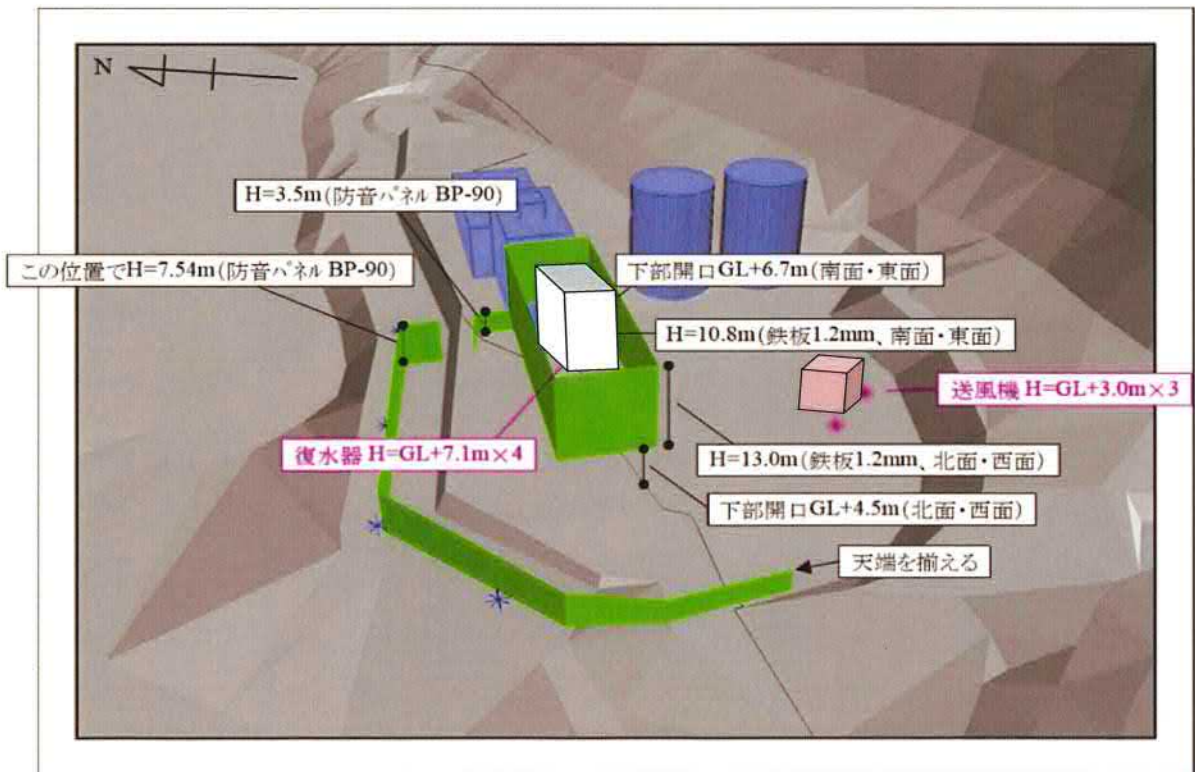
セットバック後の防音壁の位置・高さ立面図
